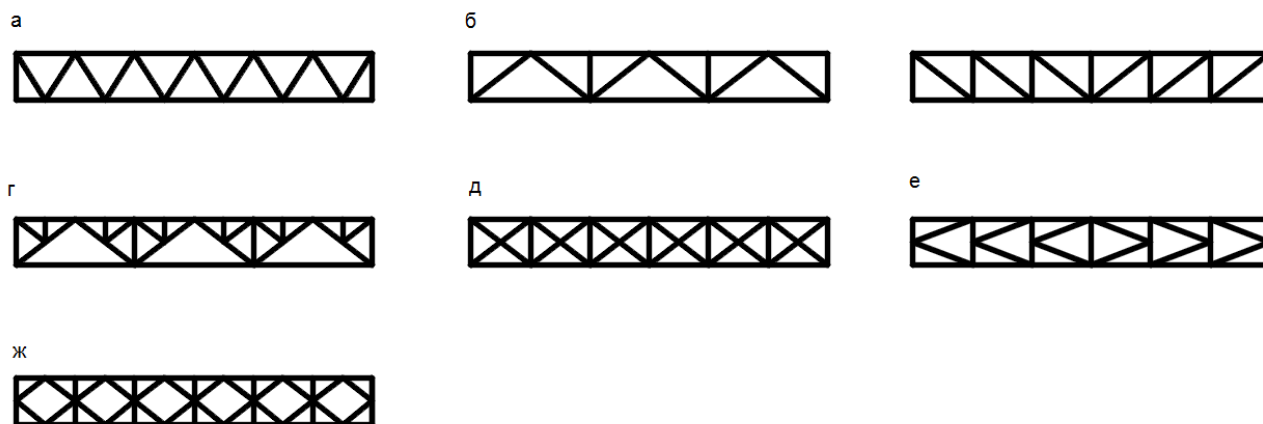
Типы решёток ферм: а- треугольная; б- треугольная со стойками; в- раскосная; г- шпренгельная; д- крестообразная; е- полукасосная; ж- ромбическая.
